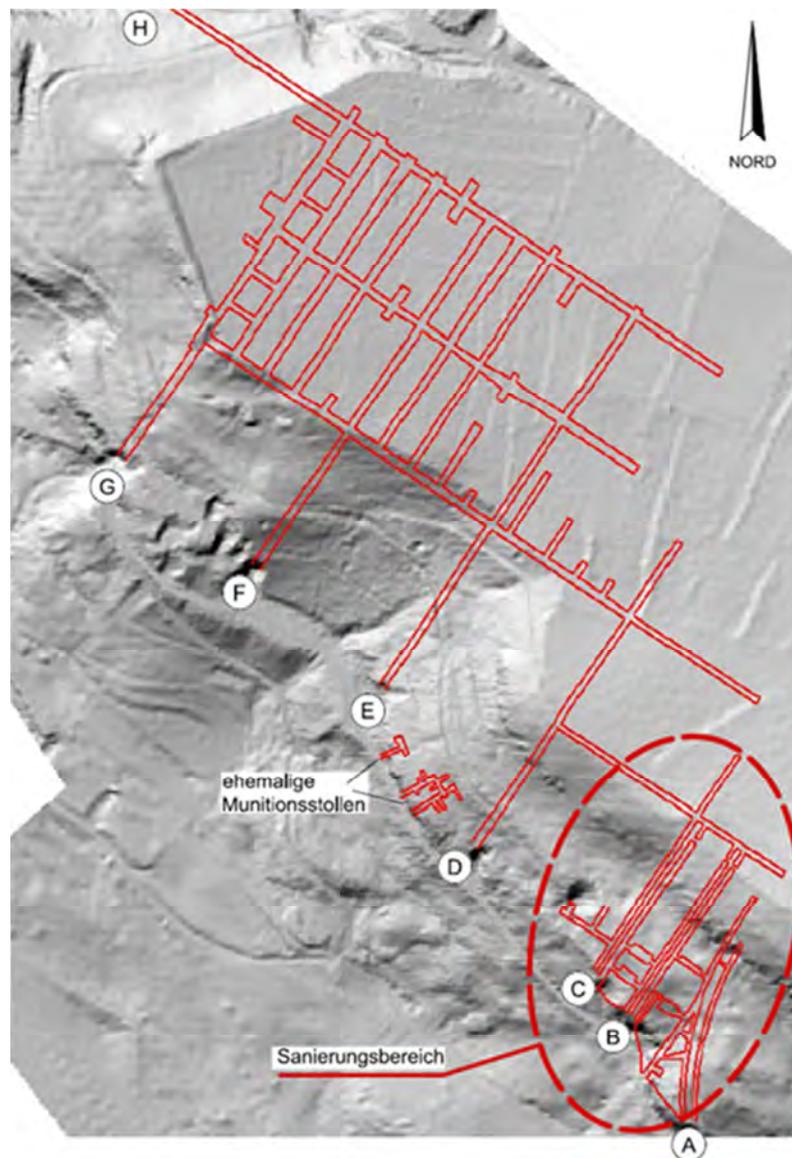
Grundriss Doggerstollen Happurg [4]
